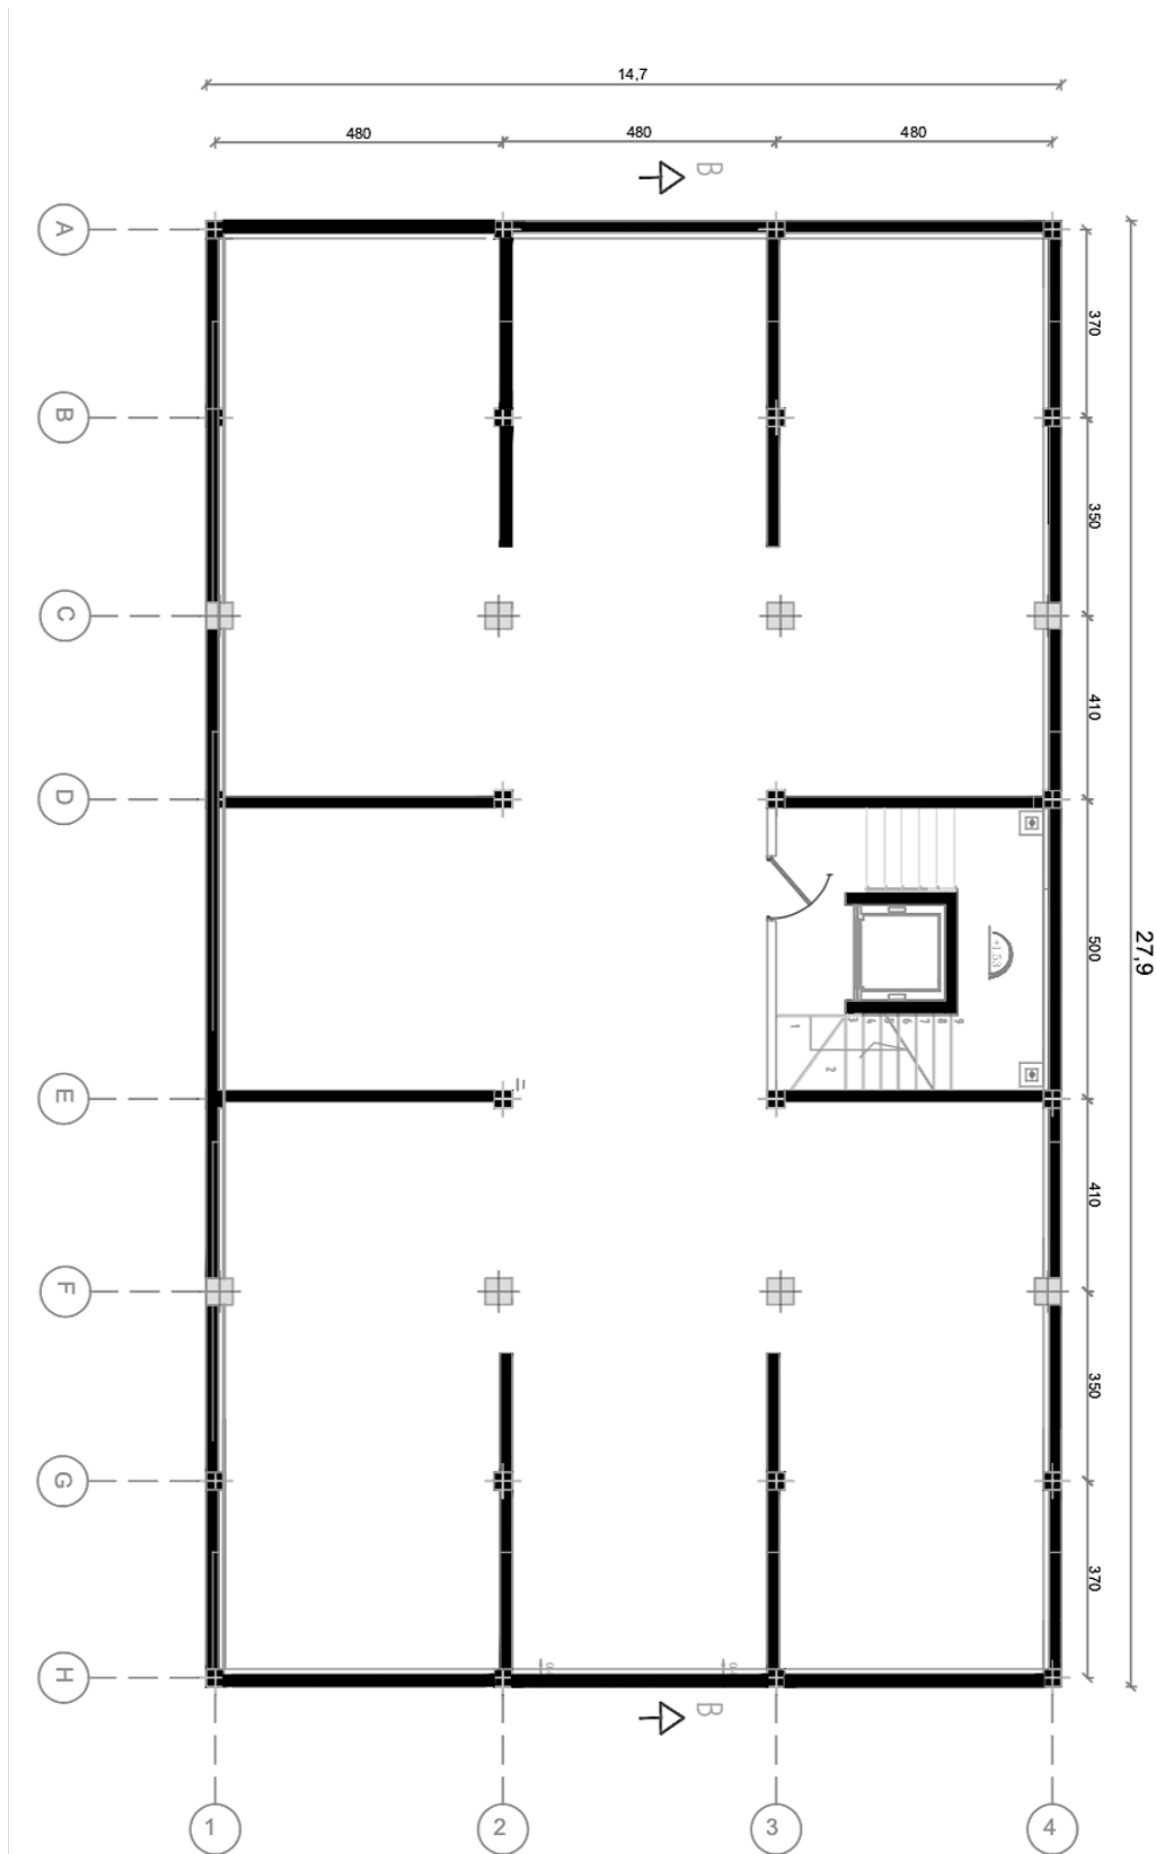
⁴⁷ - Plan sous-sol
